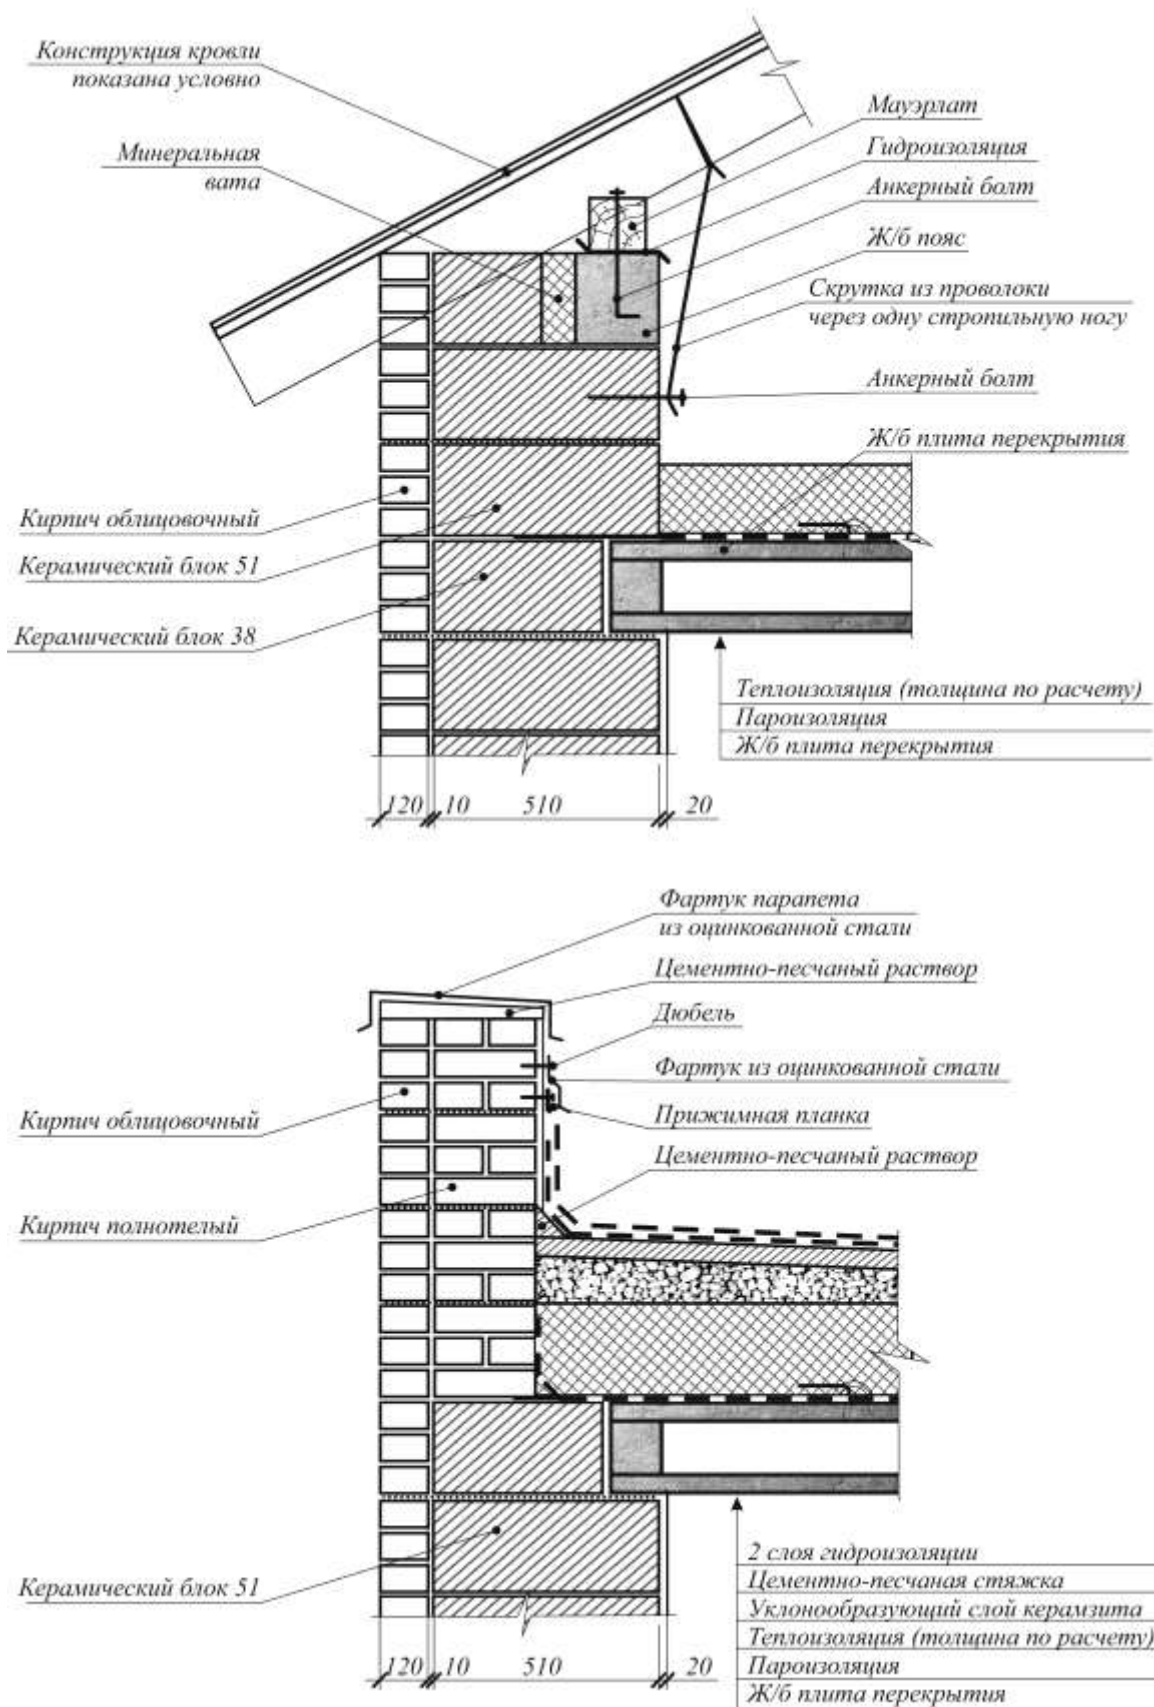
Узлы организации сопряжения наружной однослойной стены из крупноформатных блоков с чердачным перекрытием и совмещенным покрытием
